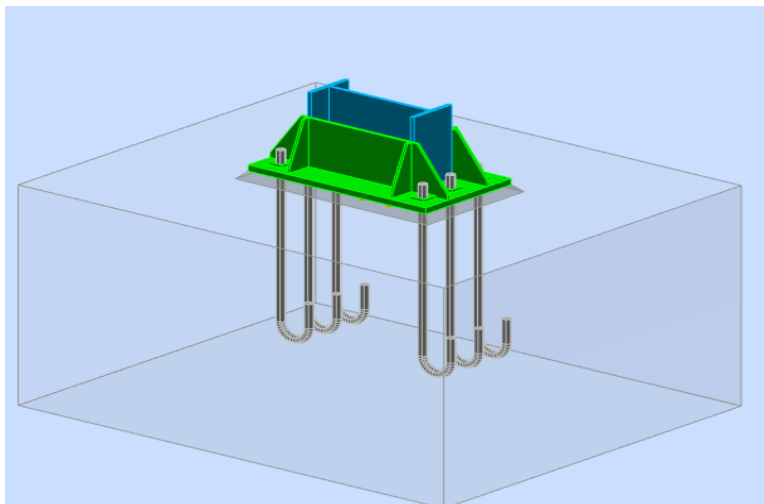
Vue 3D de l'assemblage au niveau du pied de poteau
